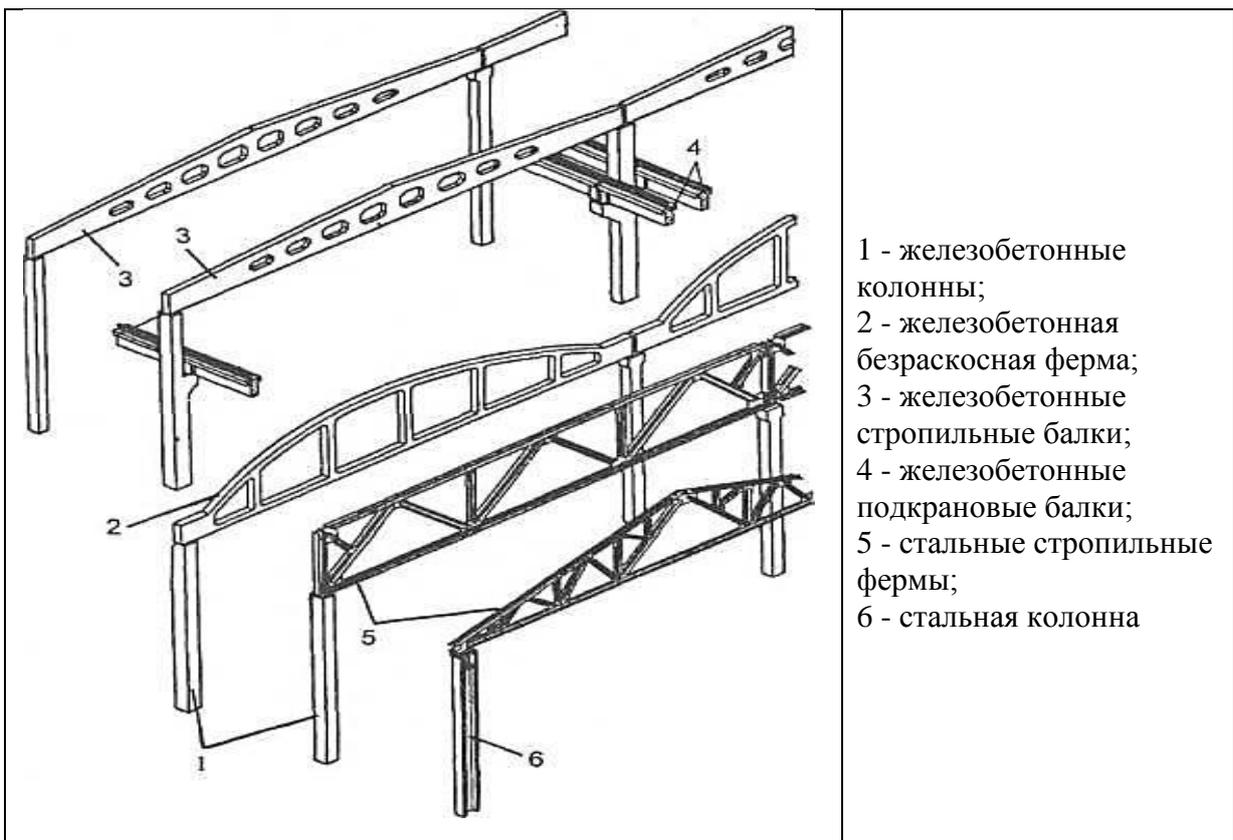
Железобетонные и стальные конструкции промышленных зданий
